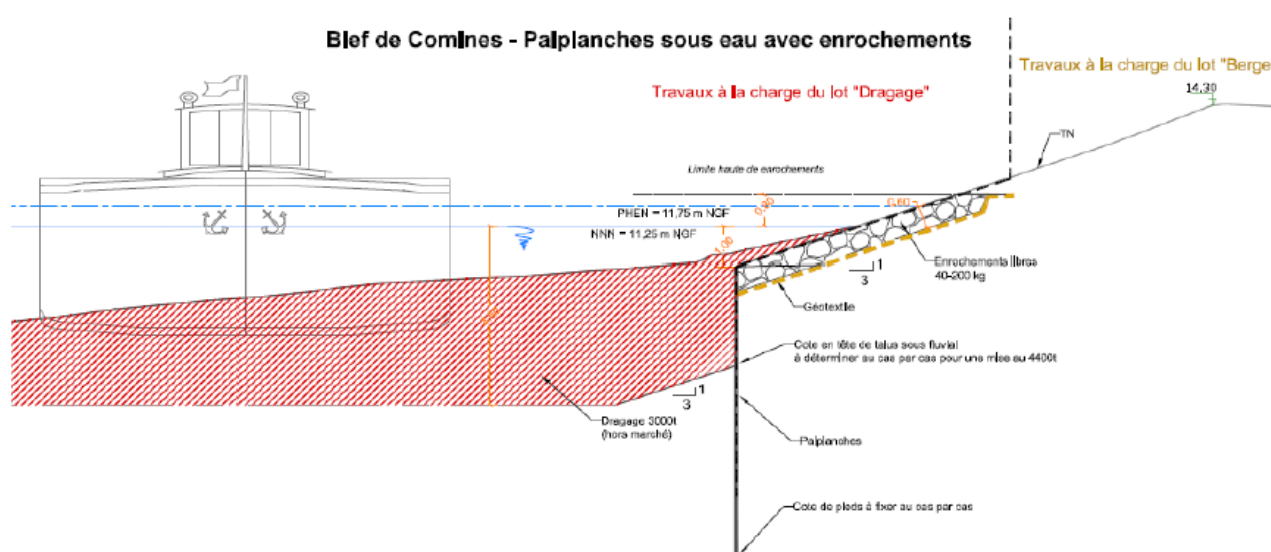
schéma de principe d'un profil raidi avec palplanches sous eau (source : dossier)
